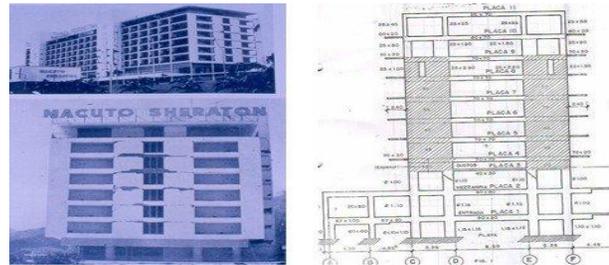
Esquema Estructural del Hotel Macuto Sheraton, mostrando los muros de concreto armada en los niveles superiores y las columnas en los niveles inferiores (Svojsik de Beek, 1980).
